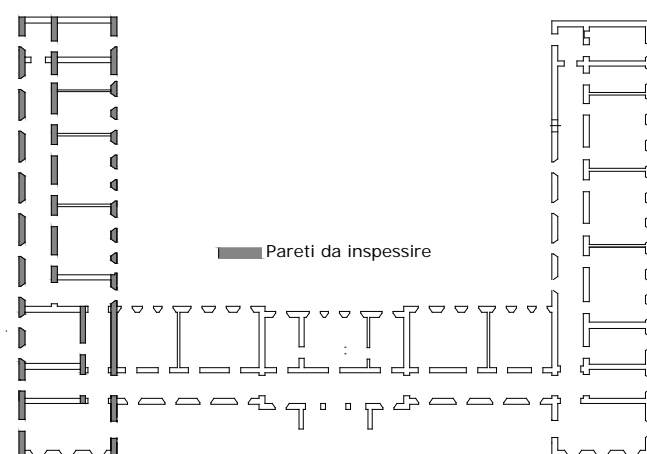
Adeguamento scuola N.Sauro pianta piano terra
